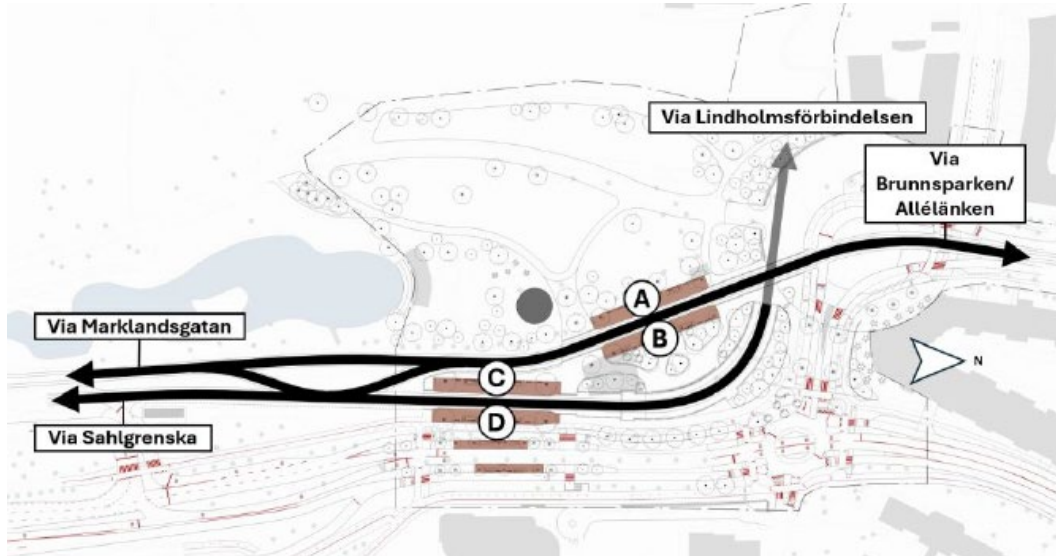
Översiktsbild på planerade hållplatslägen. Norr i riktning åt höger. (Illustration från Förslagshandling allmän plats, COWI, 2025-11-28).
